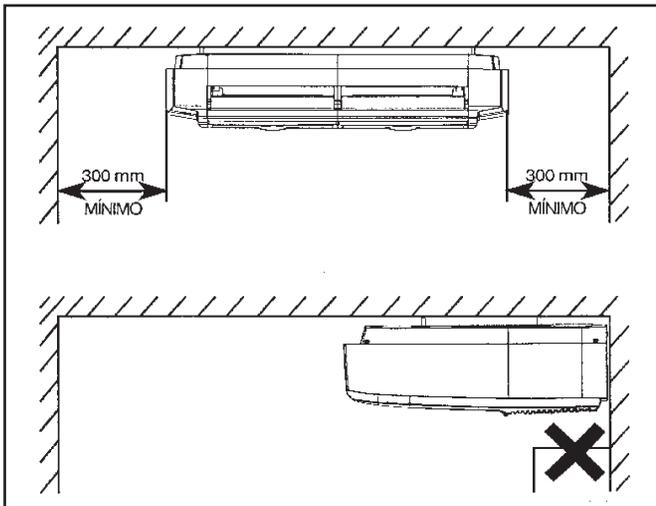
MONTAGEM TETO - UNDER CEILING
